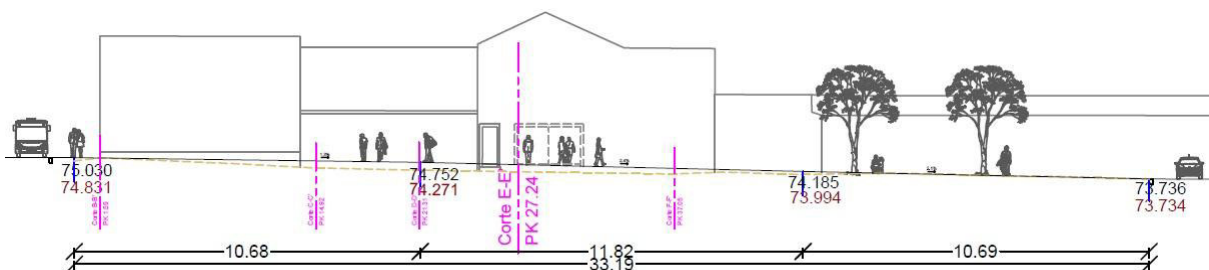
Corte Longitudinal da Estrada das Garridas [76]
